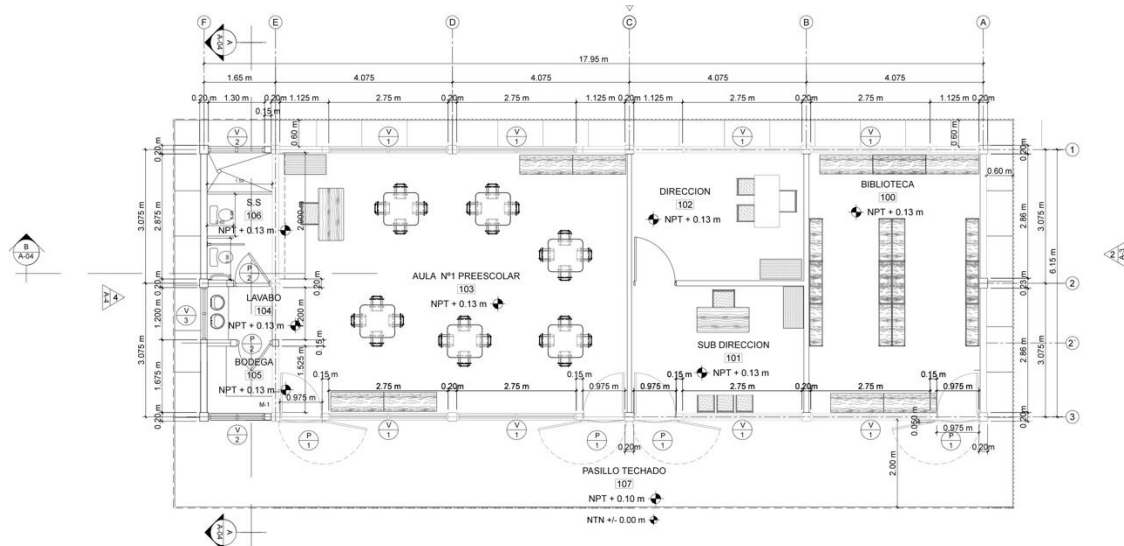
Planta Arquitectónica del Pabellón 1, Fuente: Área de Preinversión MINED
